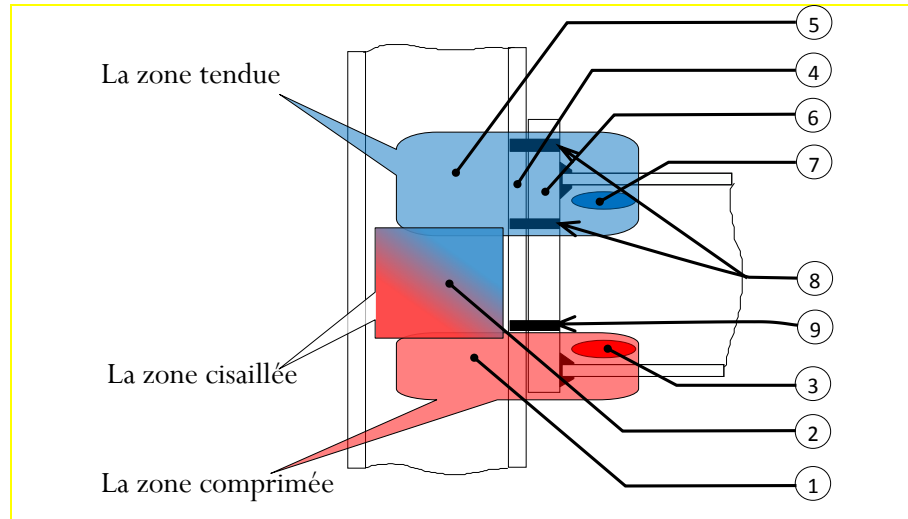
Composantes d'un assemblage poutre-poteau boulonné par platine d'extrémité.
